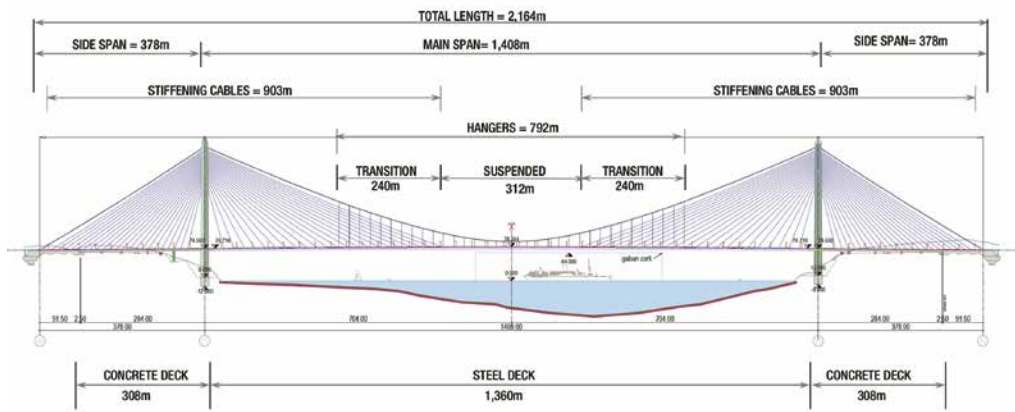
Elévation géométrique globale de l'ouvrage - définition des zones structurales
